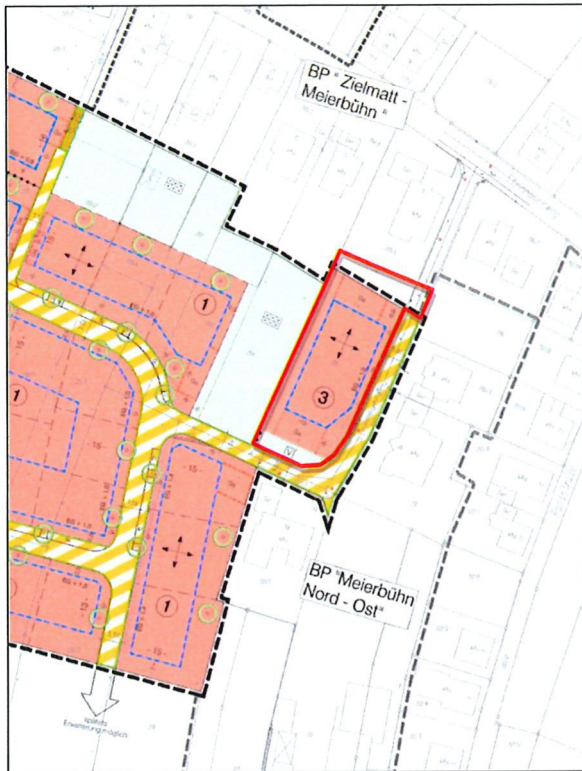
Planzeichnung des Bebauungsplanes „Meierbühn-Westtangente“, rechtsverbindlich seit dem 28.11.2008, mit schematischer Darstellung des Änderungsbereichs der zeichnerischen Festsetzungen (rot)
